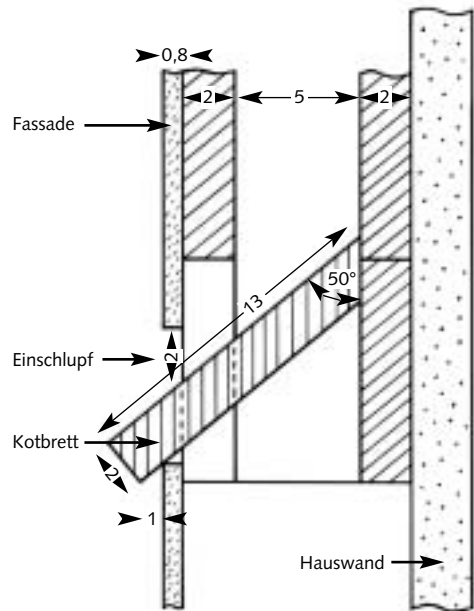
Detail des Fledermauskasten in Dämmfassade (Zeichnung nach STAPEL; Maße in cm)
